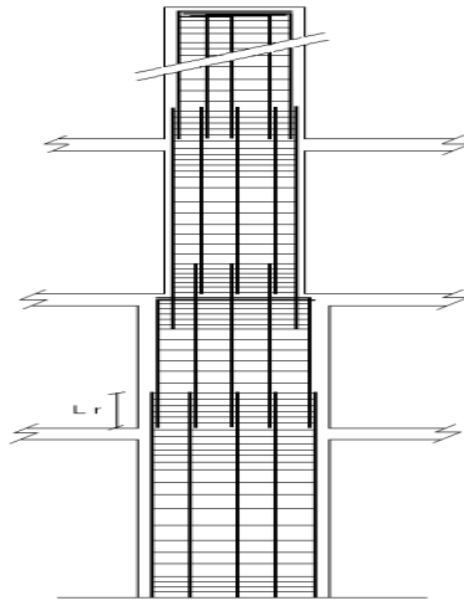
Coupe en élévation et détail de ferrailage des poteaux
